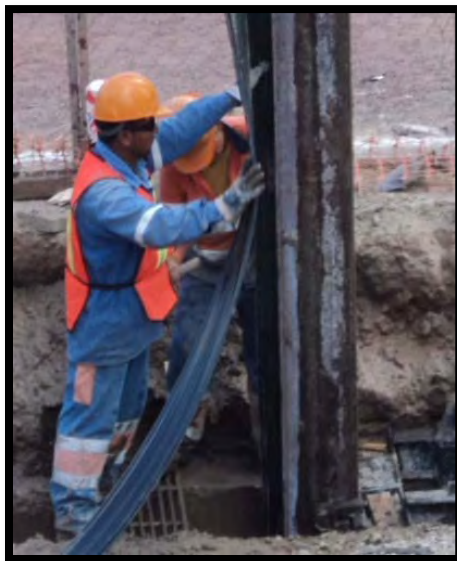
Junta WaterStop colocada en colado de muro Milán.
